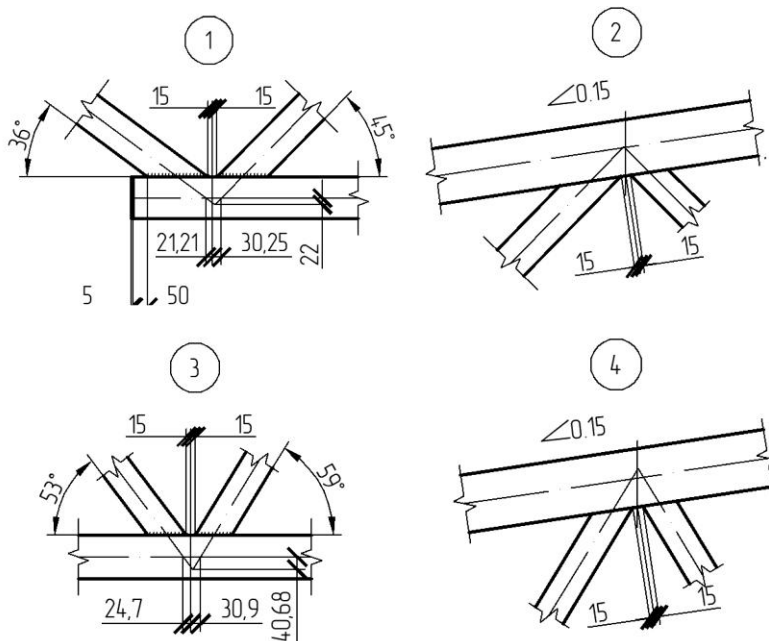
Узлы стропильной фермы с уклоном верхнего пояса 15 %
